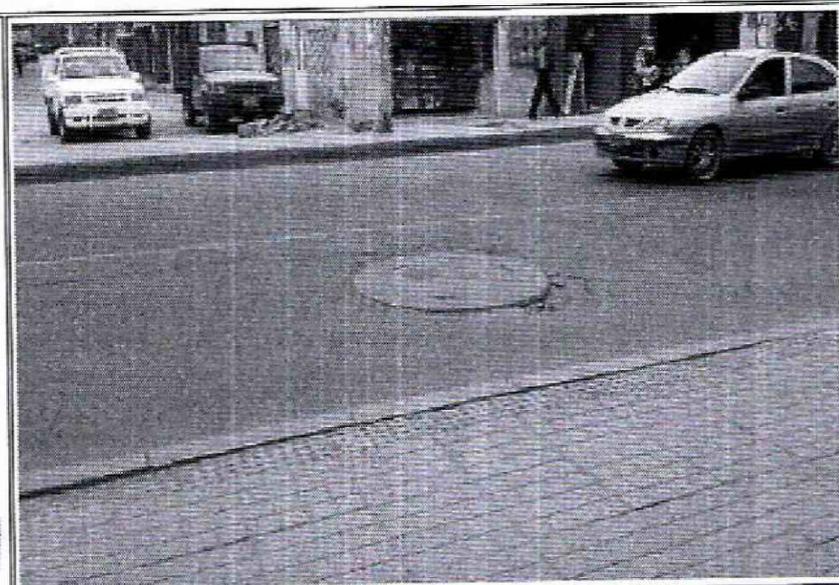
Hundimiento entre el cargue y la estructura de la vía pozo inspección alcantarillado
